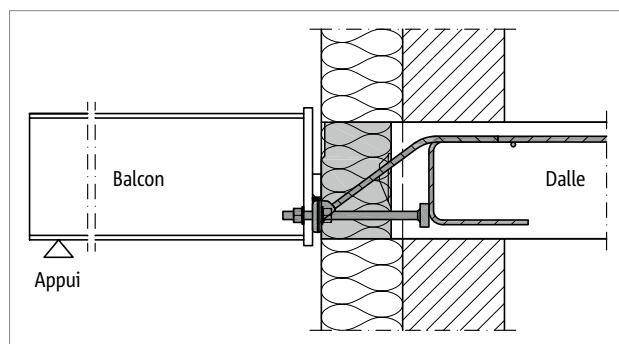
Schöck Isokorb® XT type SQ : Le corps isolant affleure le nu extérieur de l'isolation du mur grâce à la saillie de la dalle vers l'extérieur. Ce faisant, les distances aux bords latéraux doivent être respectées
